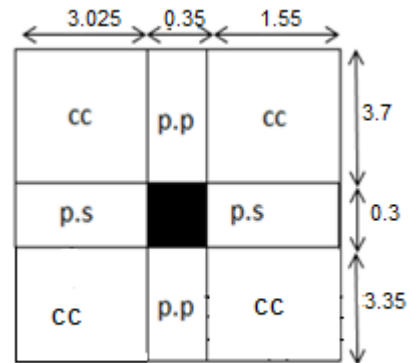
La surface qui revient au poteau p1 terrasse inaccessible
